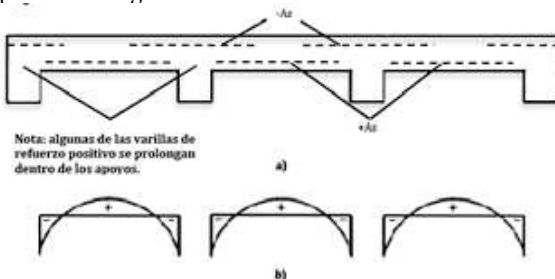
a) Recomendación de distribución de hierros, b) momentos en sección transversal de una losa continua de concreto reforzado [2].
